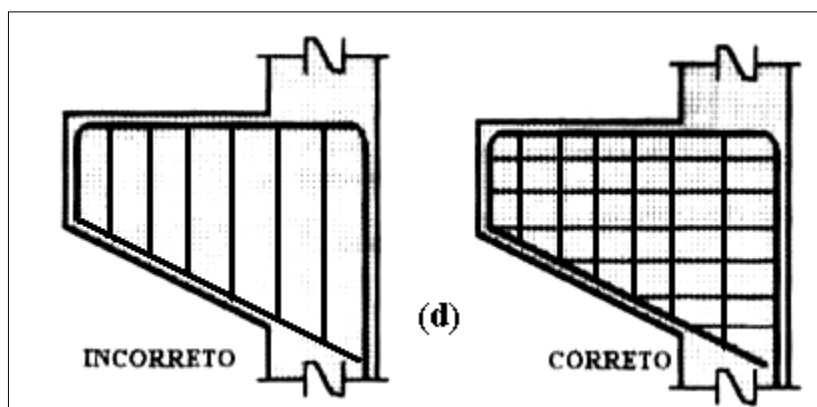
Detalhe da armadura para combater o empuxo no vazio
